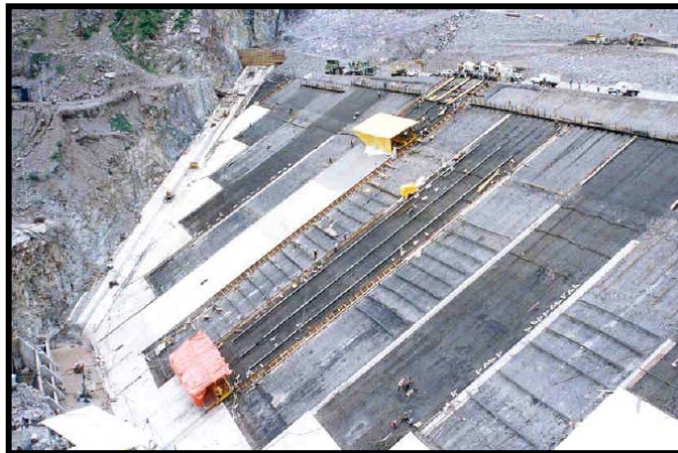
Proceso de construcción de la cara de concreto con uso de cimbras deslizantes, ollas revoledoras para el suministro del concreto y canalones para el llenado de la cimbra
